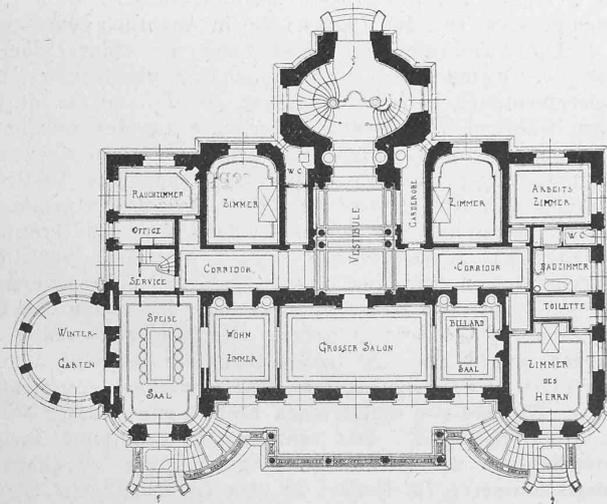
Grundriss vom Erdgeschoss.
